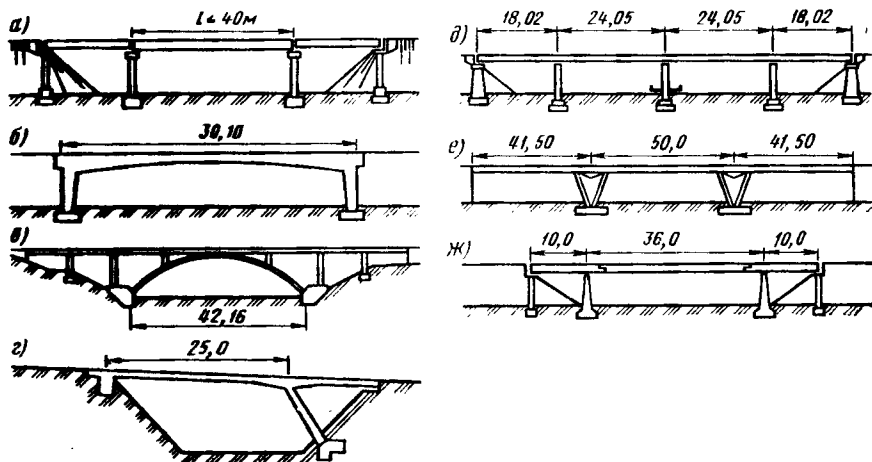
Схемы железобетонных путепроводов балочной, арочной и рамной систем
